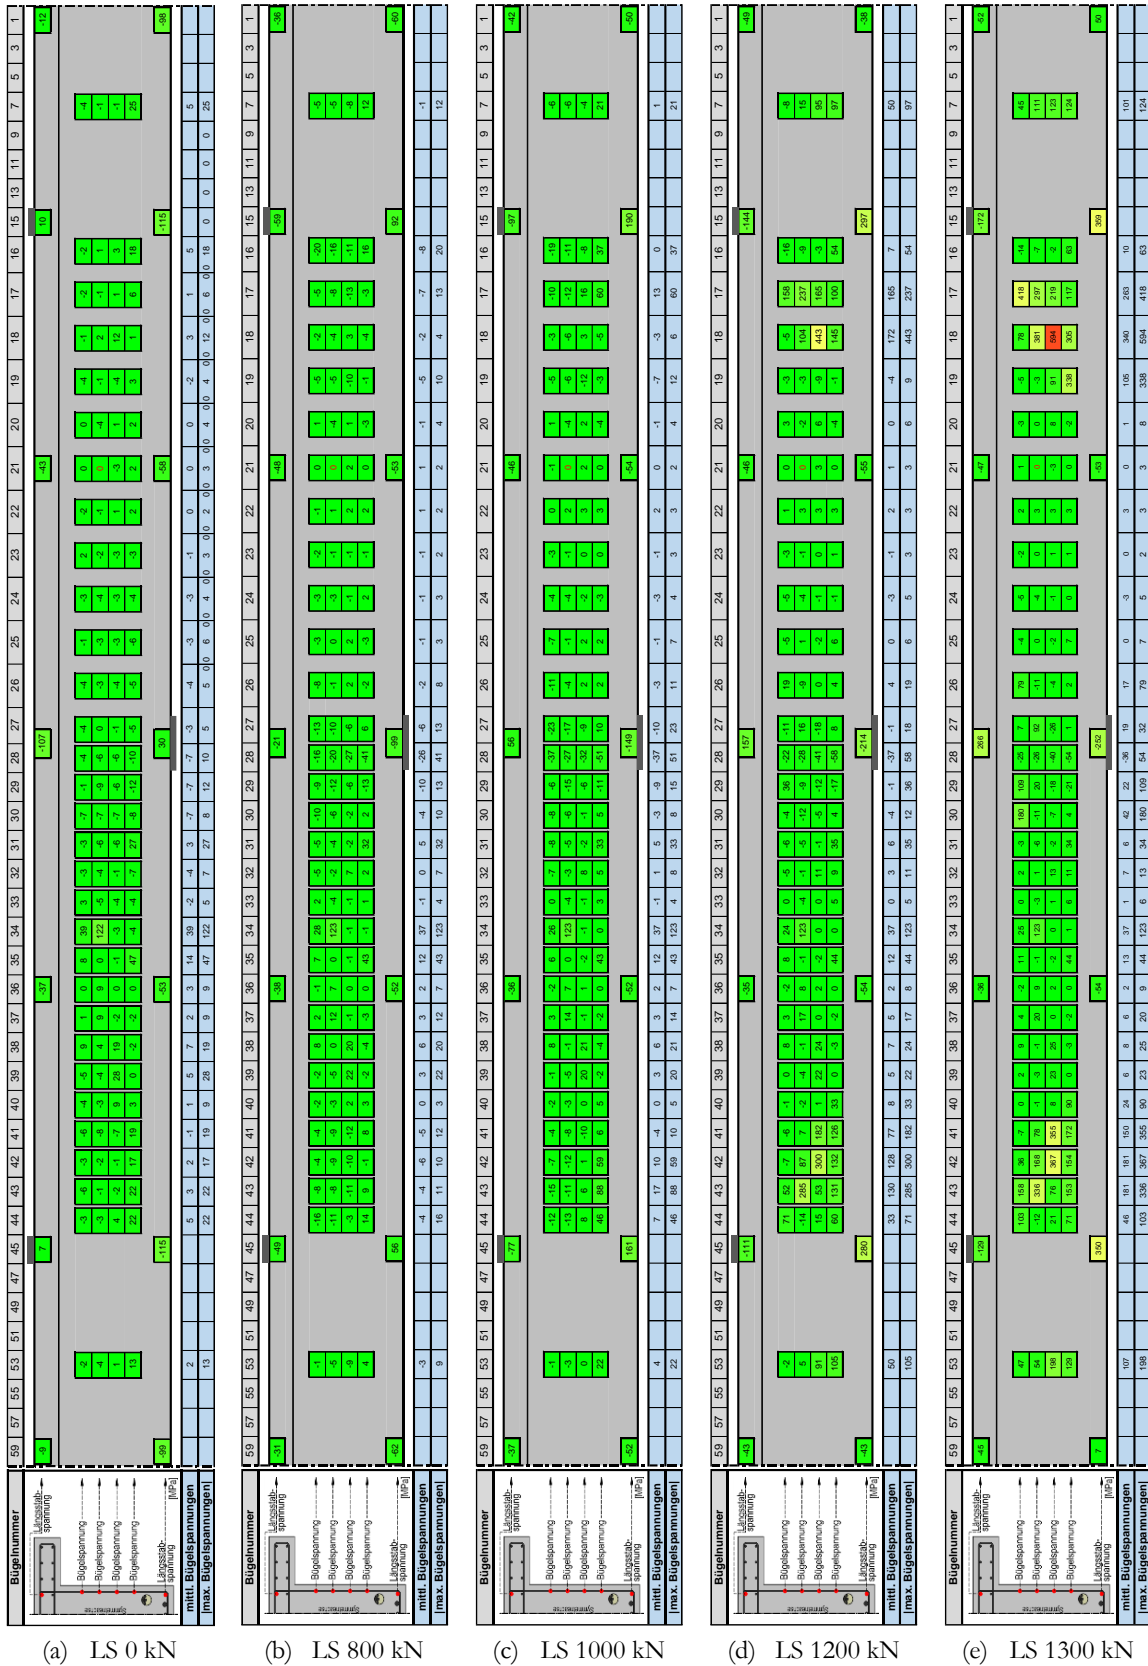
Betonstahlspannungen des Versuchsträgers DLT 3 für ausgewählte Laststufen, Teil 1
